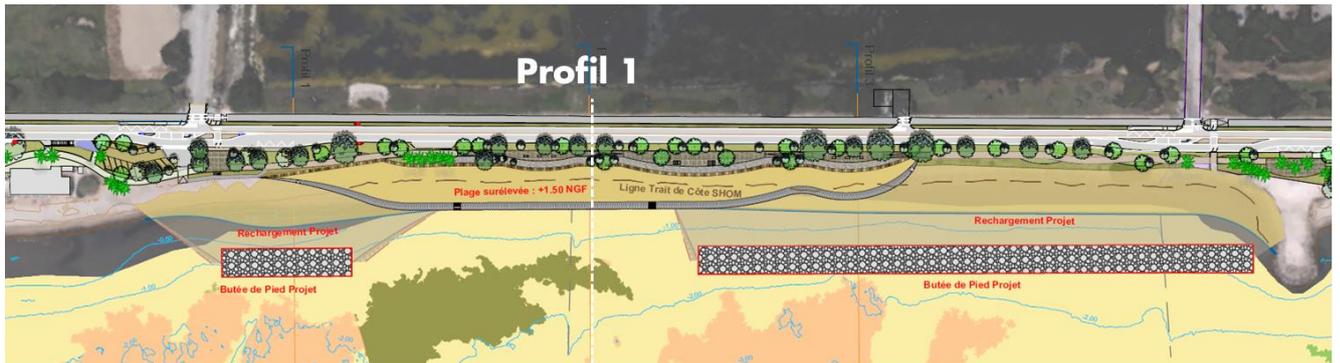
Vue en plan Solution 2 (avec plage suspendue au droit de l'herbier) phase AVP
